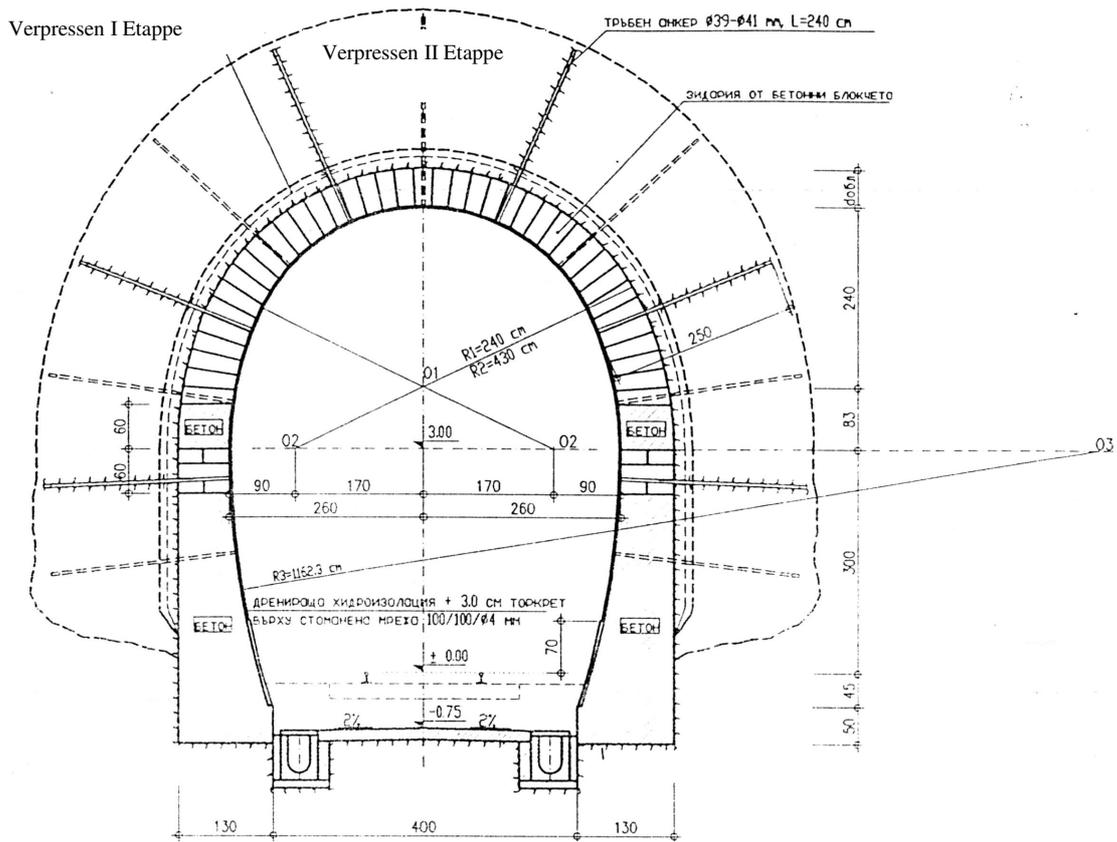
Typenquerschnitt mit einer Hydroisolation, Sicherung des existierenden Tunnelausbaus
